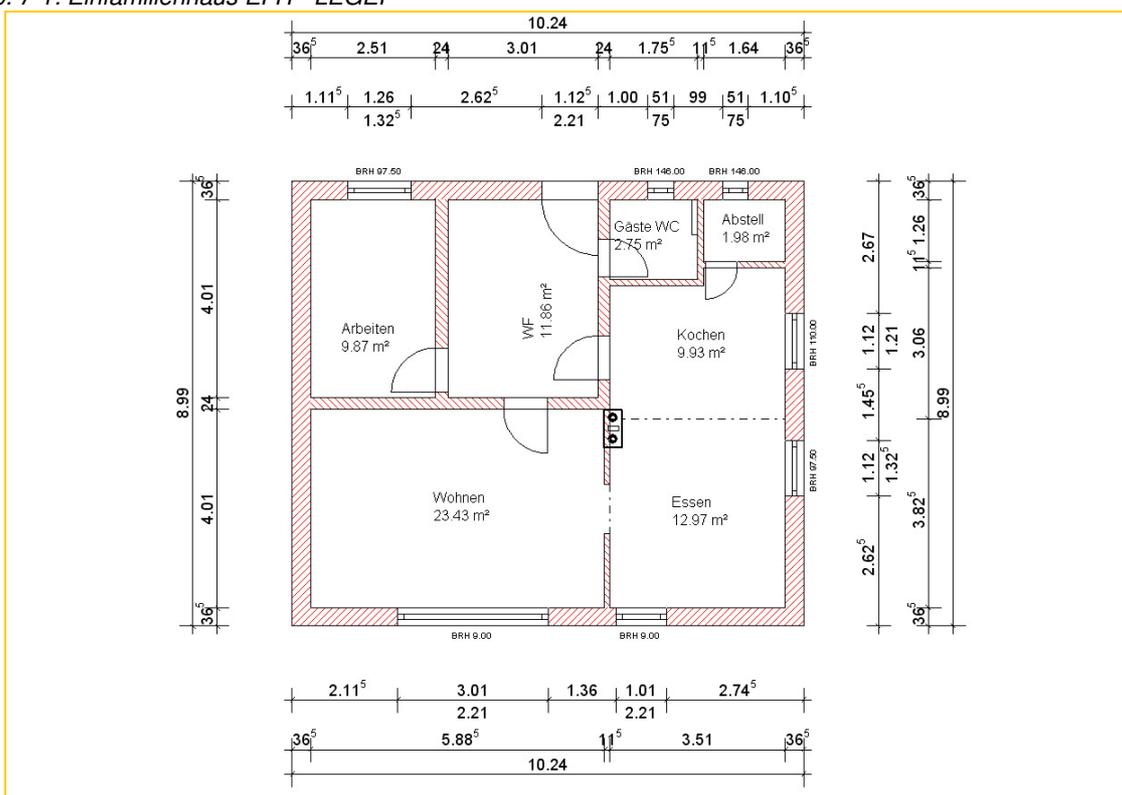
Grundriss Einfamilienhaus EG
